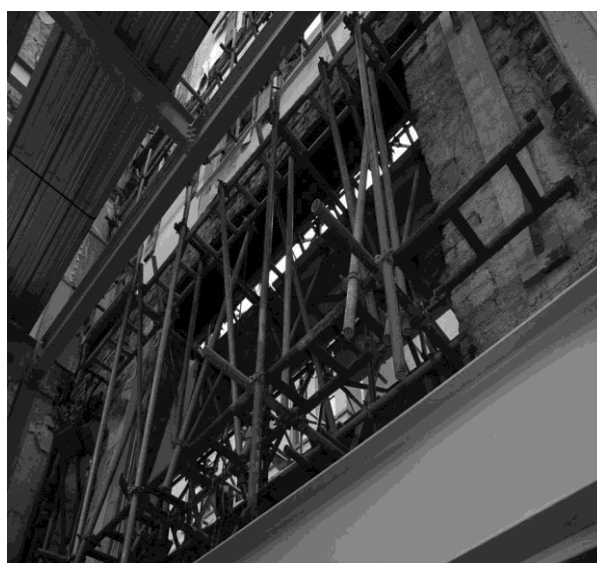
Pormenor de ligação entre a estrutura e a fachada [2].
